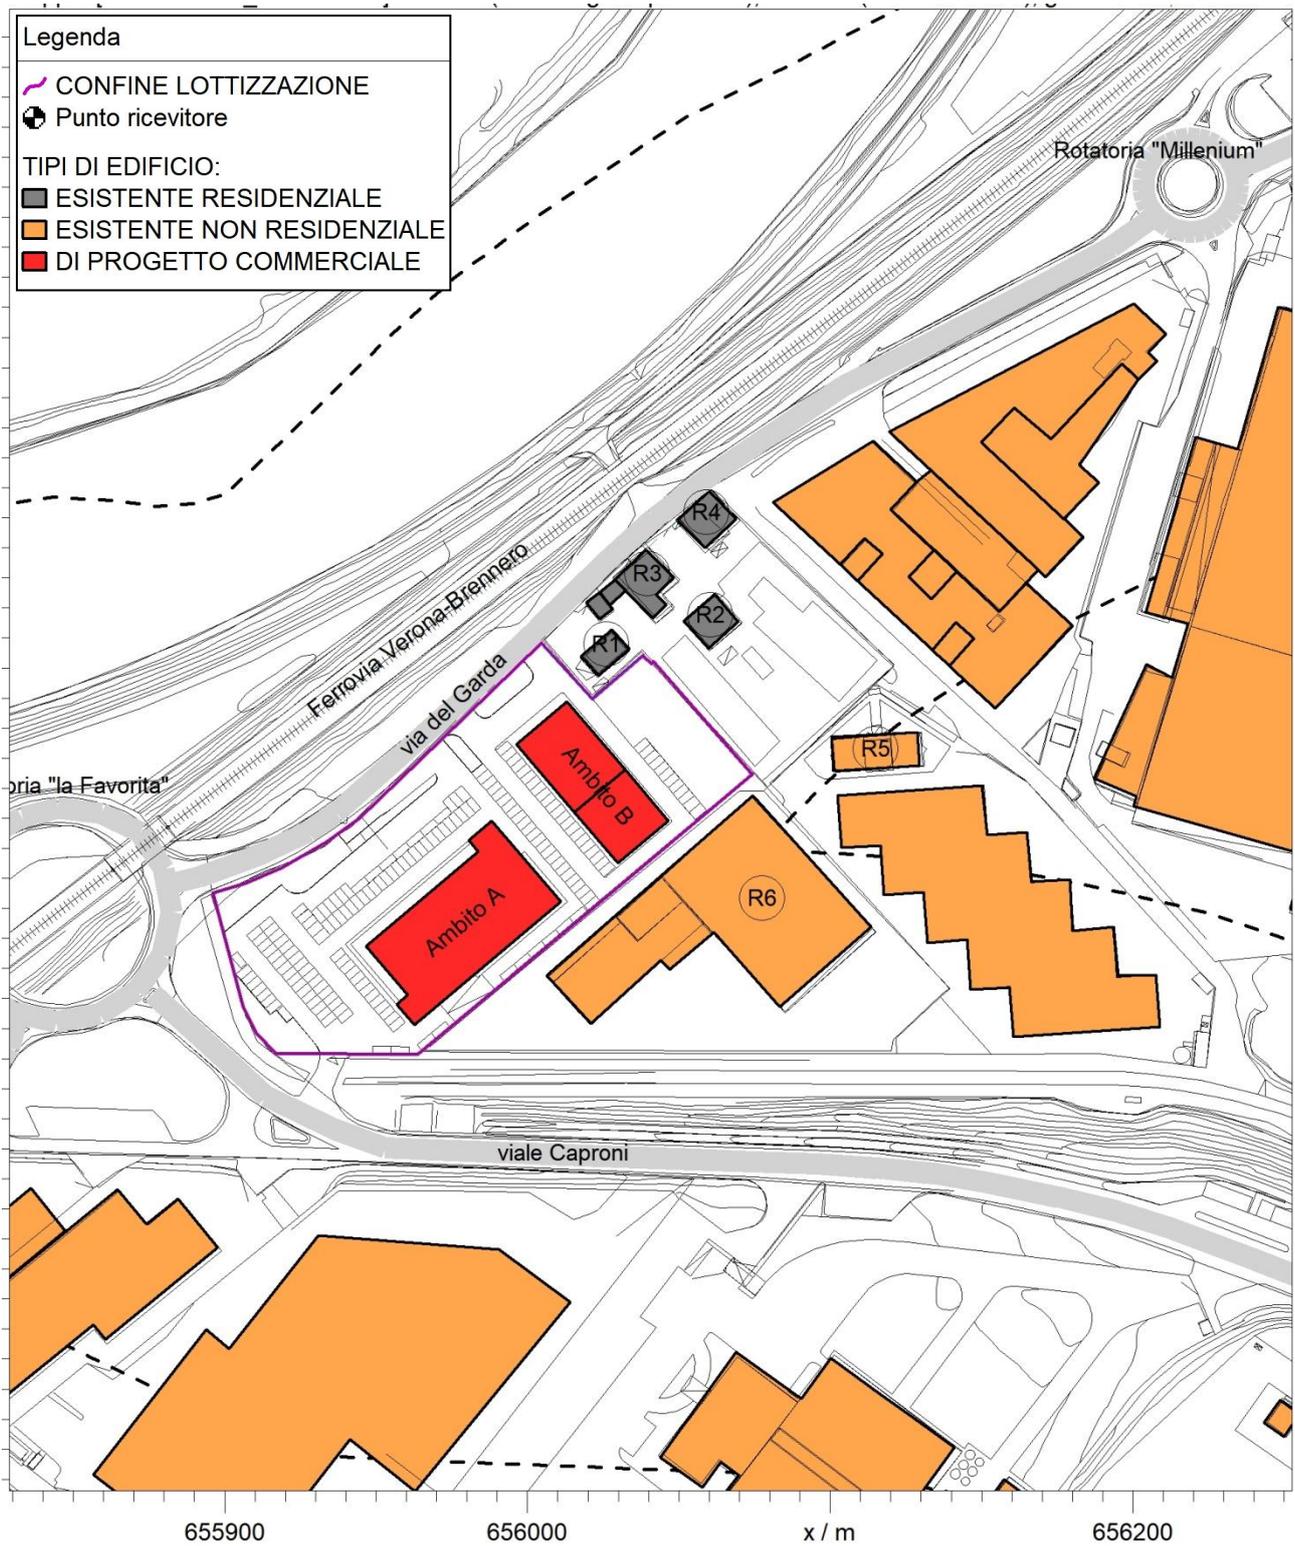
planimetria layout del PdL in area "La Favorita"- stato di progetto
